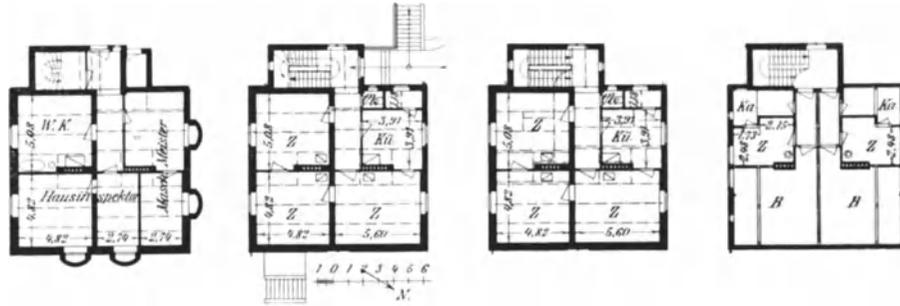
Beamtenwohnhaus. (Kellergeschoß, Erdgeschoß, I. Stockwerk, Dachgeschoß.)
